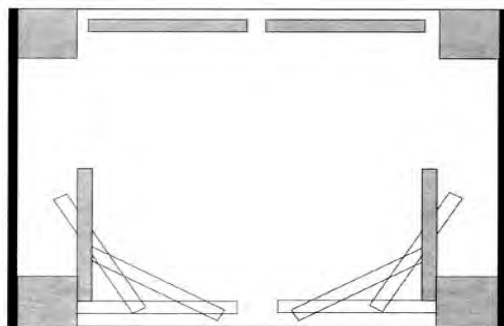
Шлюз с двухстворчатыми дверьми с плоскими поворачивающимися створками
